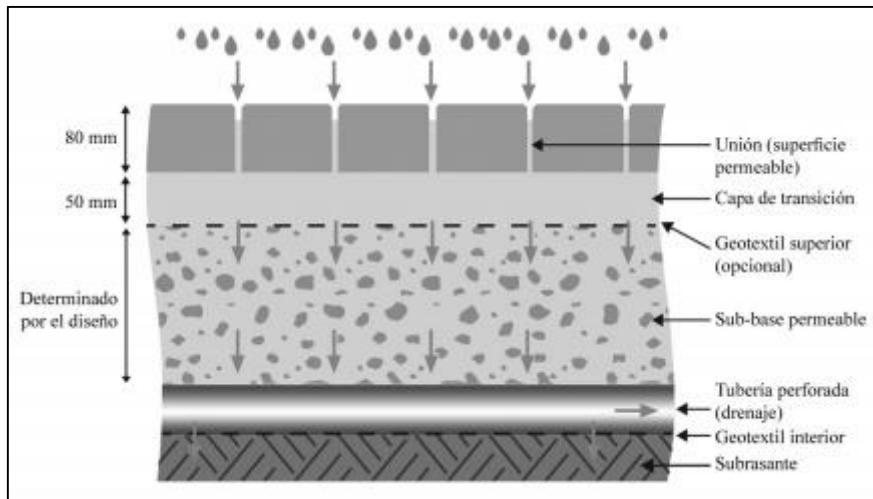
Estructura típica de pavimento permeable con infiltración parcial
